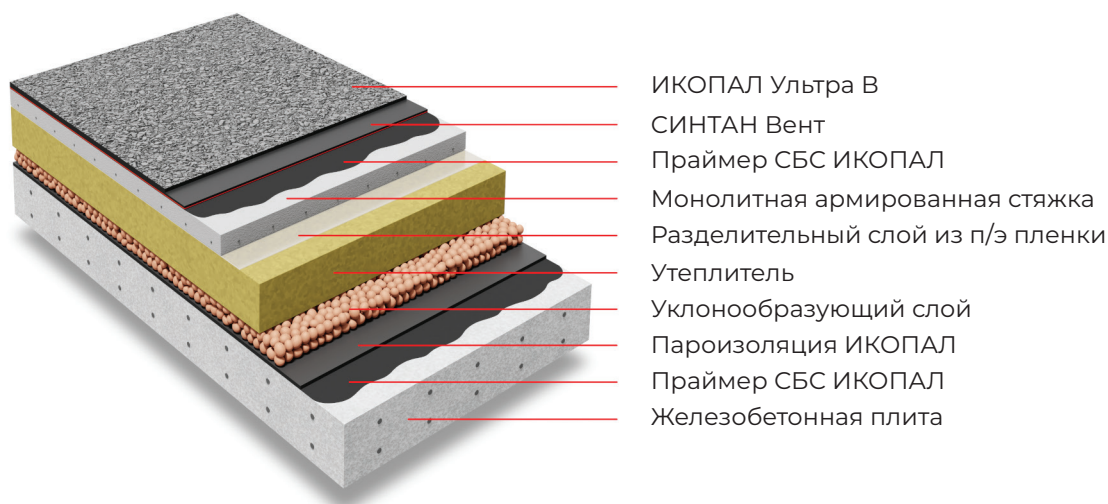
Вариант неэксплуатируемой вентиляруемой кровли с двухслойным кровельным ковром
